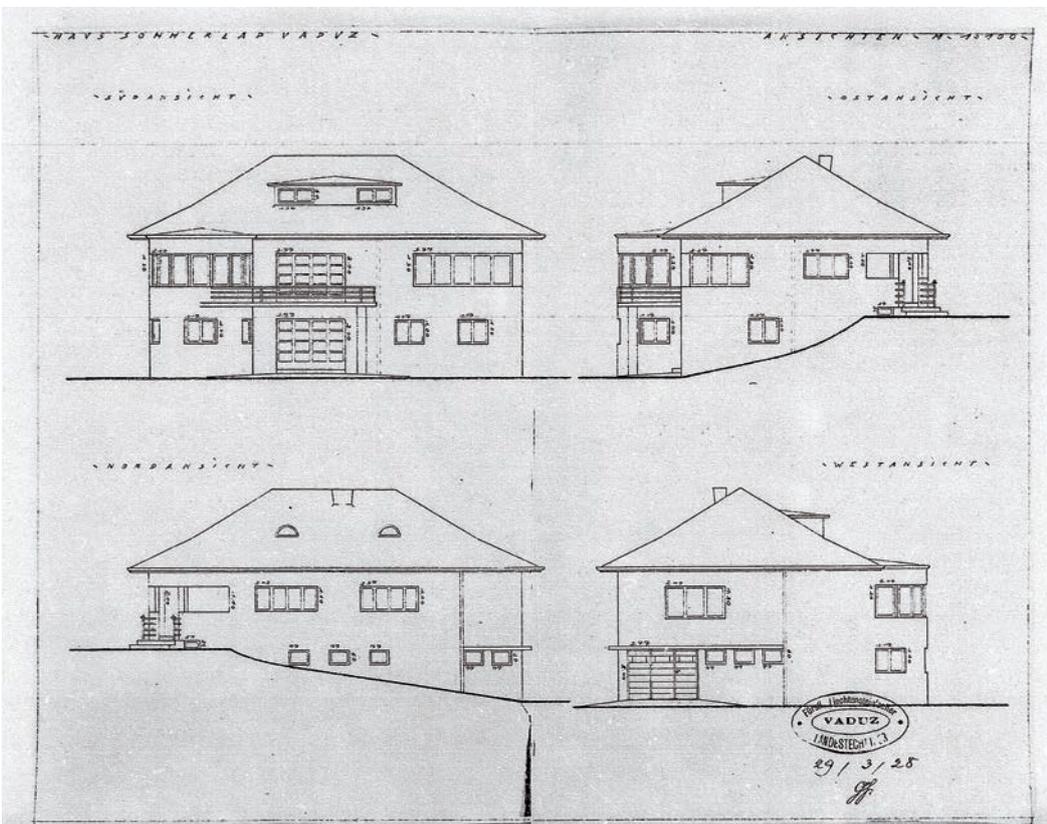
Pläne Bauakt Nr. 1928/22, Fassadenansichten.
